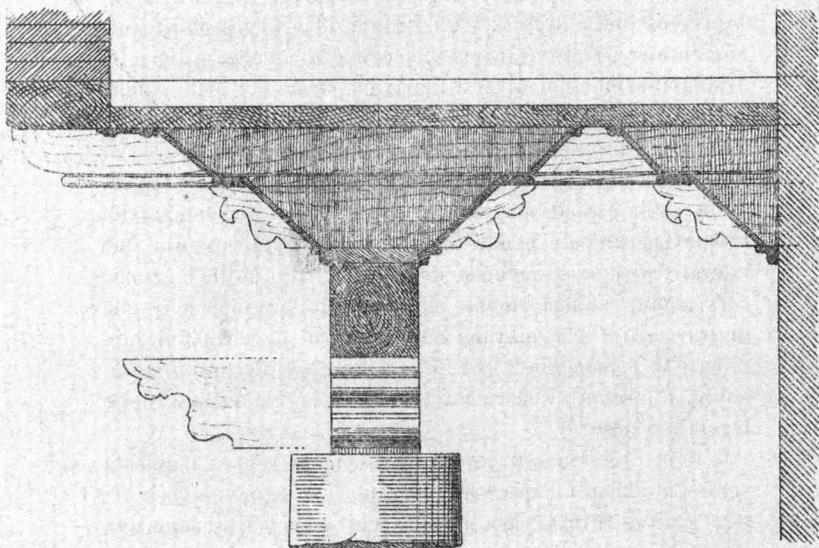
Sezione trasversale d'un soffitto (1 a 25).
